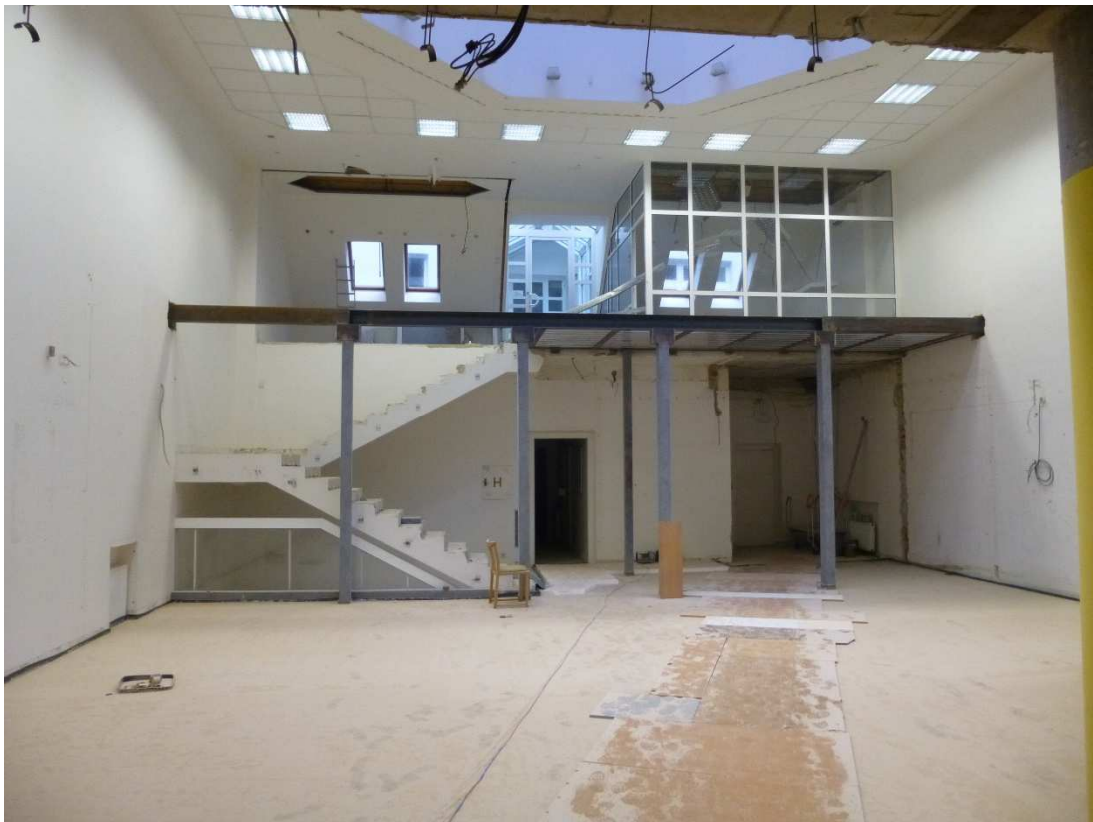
Odhalená stropní deska – na několika místech nutná sanace betonových konstrukcí
